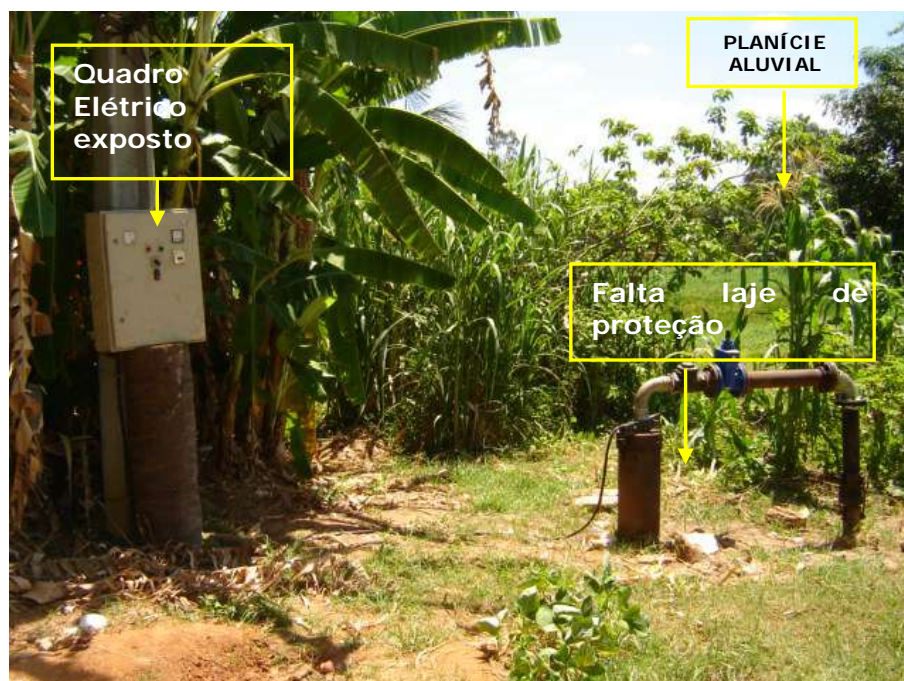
Área do Poço PT-08; Faltam Piso, Laje de Proteção, Capina e Isolamento da Área; Quadro de Comando e Fiação Expostos; Poço Construído Dentro da Planície Aluvial; Alta Vulnerabilidade
